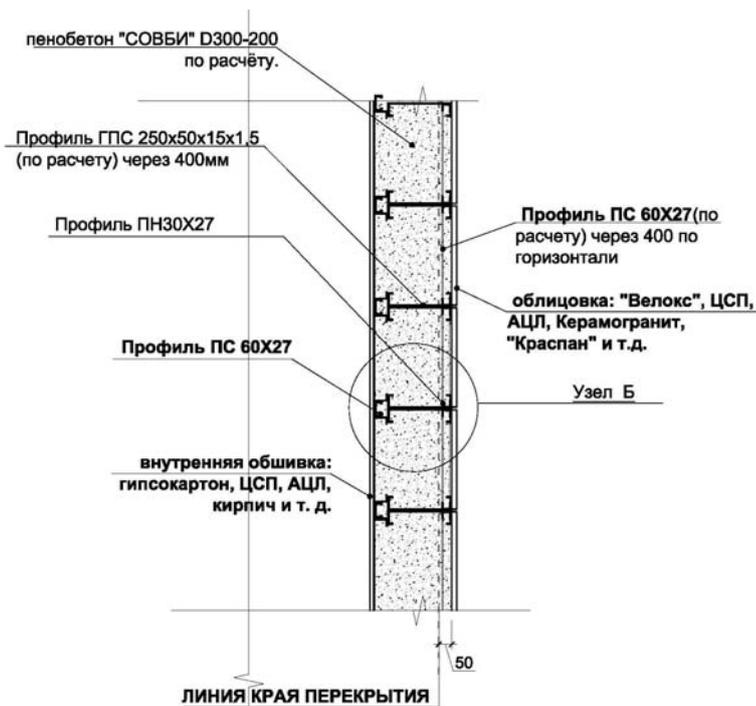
Пример стены с несъёмной опалубкой из листового материала
